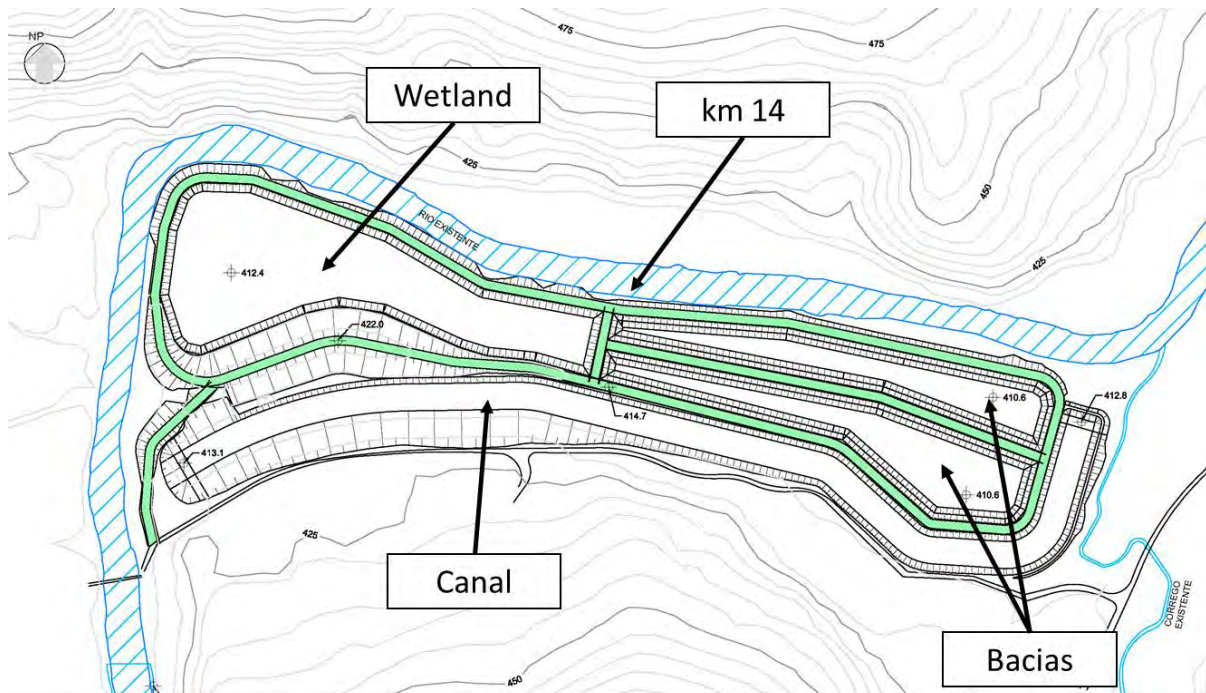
Ilustração do layout preparado para o projeto conceitual do site GN-STN km 14
